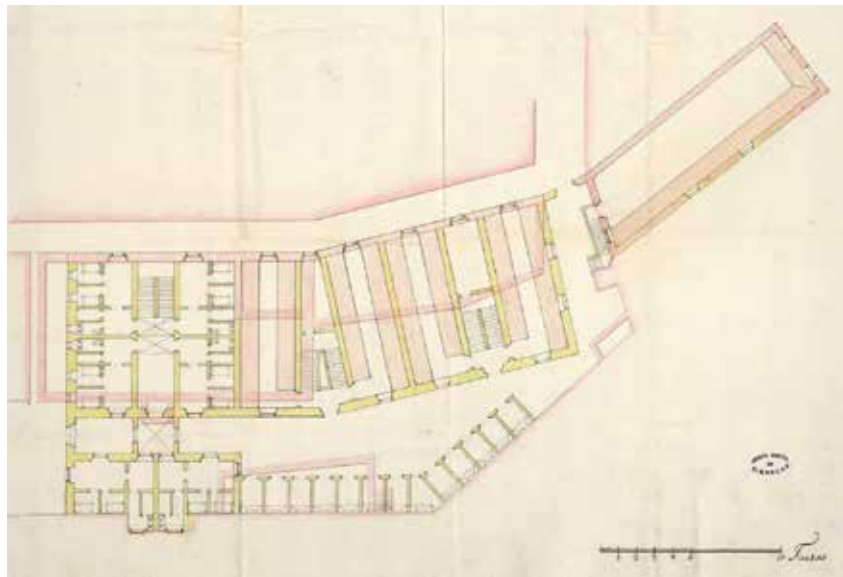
Planta primera y Secciones y planta baja, 1738, AG Simancas, MPyD 27.53 y 28.01. Contra propuesta del ingeniero Jaime Sicre en el mismo sitio de las fig.147-148 .
